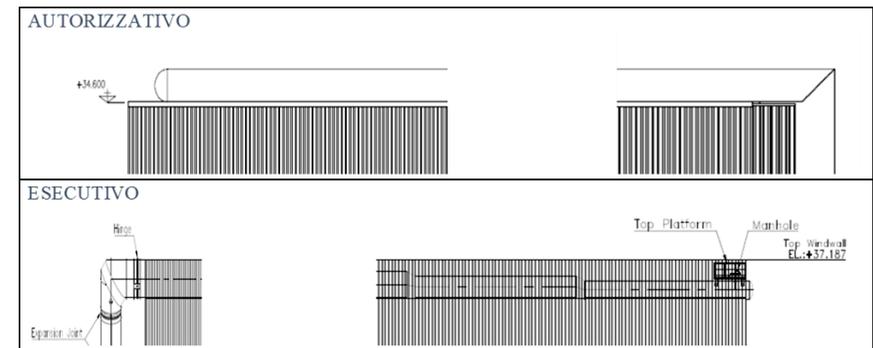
Confronto autorizzato-esecutivo Edificio ACC – prospetto
